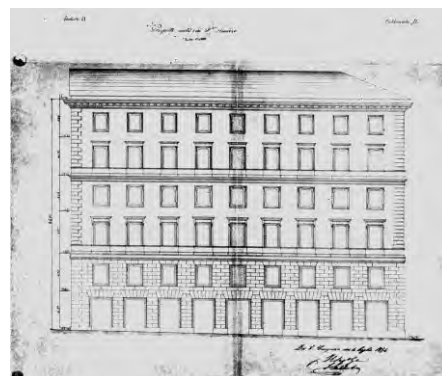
quartiere dell'Esquilino isolato IX prospetto
